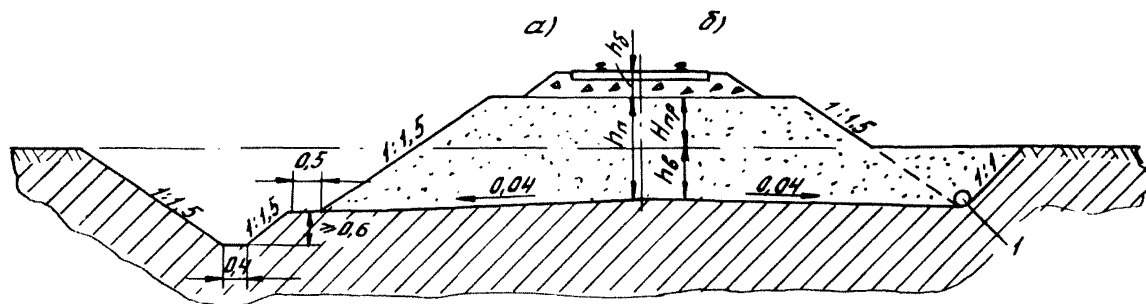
Схема устройства подушки из дренирующего грунта с заменой пучинистого грунта в основании низкой насыпи:
